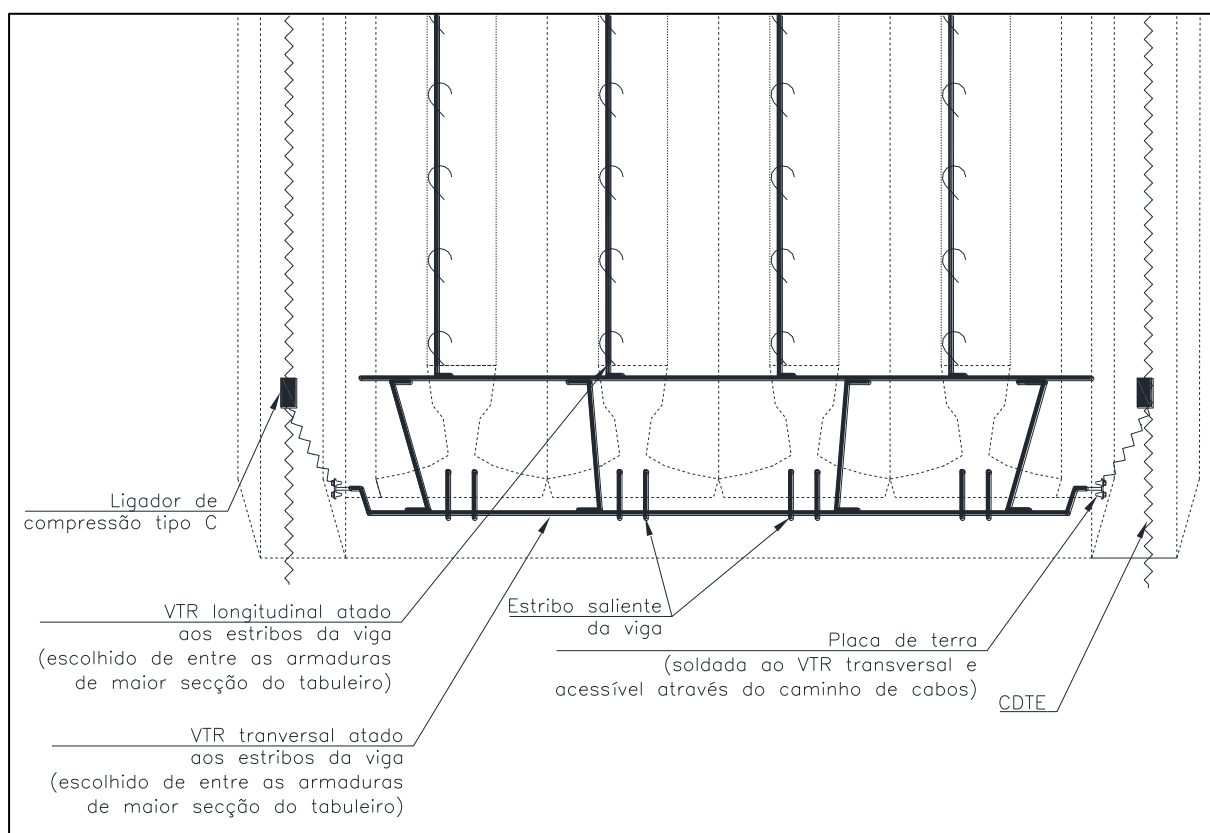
Desenho de princípio da ligação das armaduras ordinárias das vigas pré-esforçadas, ao sistema de terras
